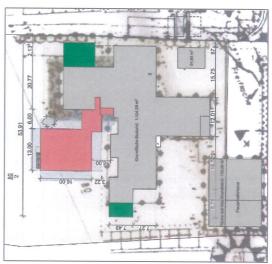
Lageplan Anbau Kita Hus Rönnau
